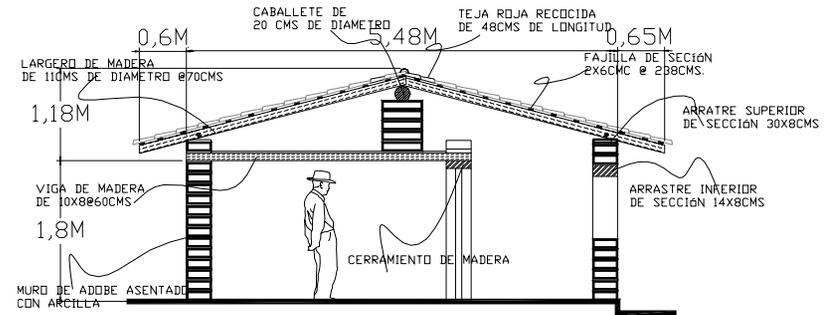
CORTE CONSTRUCTIVO DE LA FICHA No. 6.
